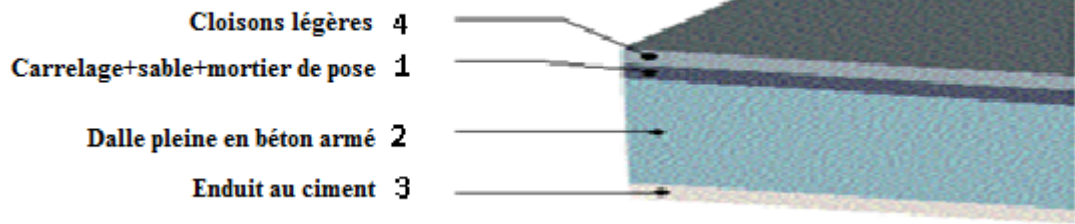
Coupe transversale d'un plancher à dalle pleine.
